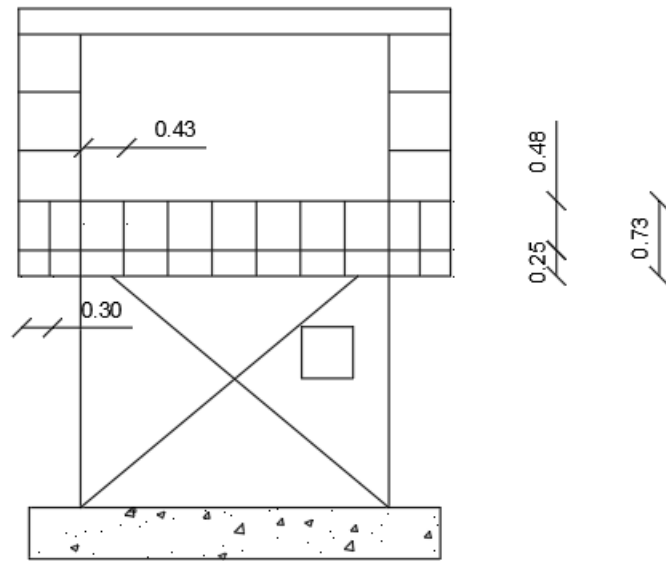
Prospetto Ovest dell'edificio a seguito delle modifiche.
